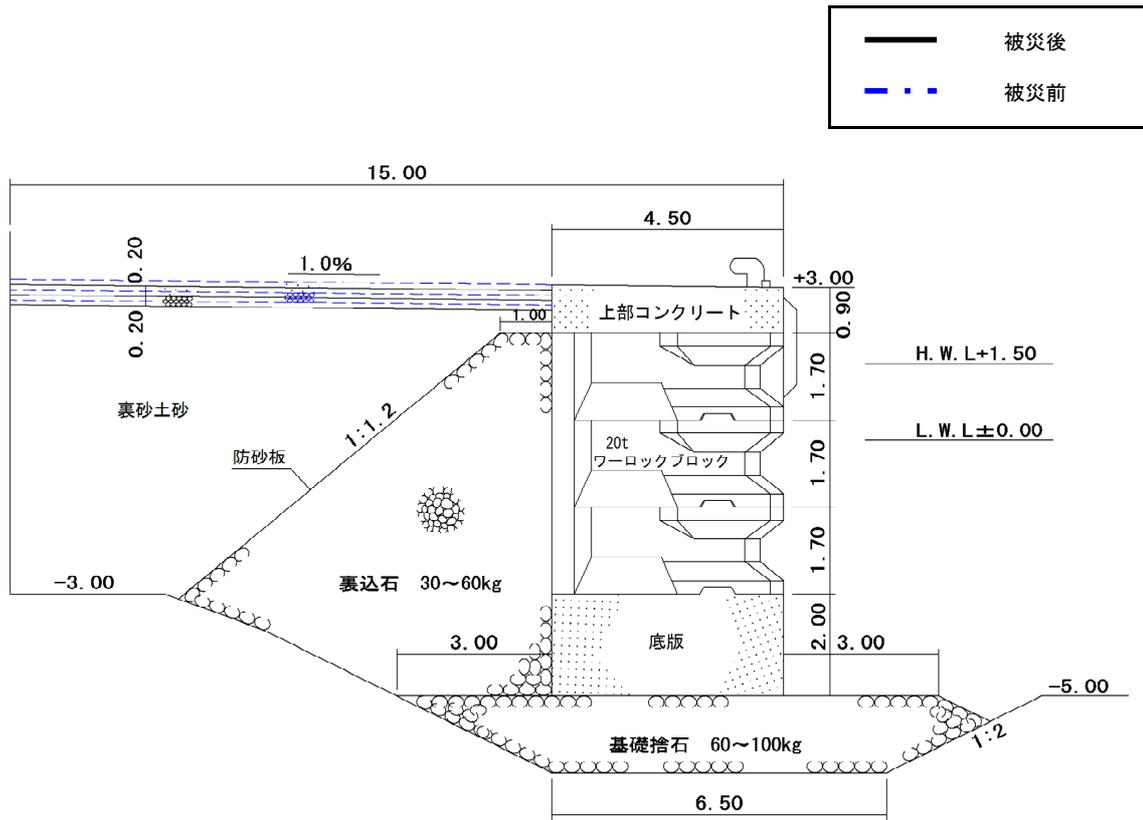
No.30 大洗港区_第2埠頭 A 岸壁 (-5.0m) (中央地区) の断面図 (被災後)
